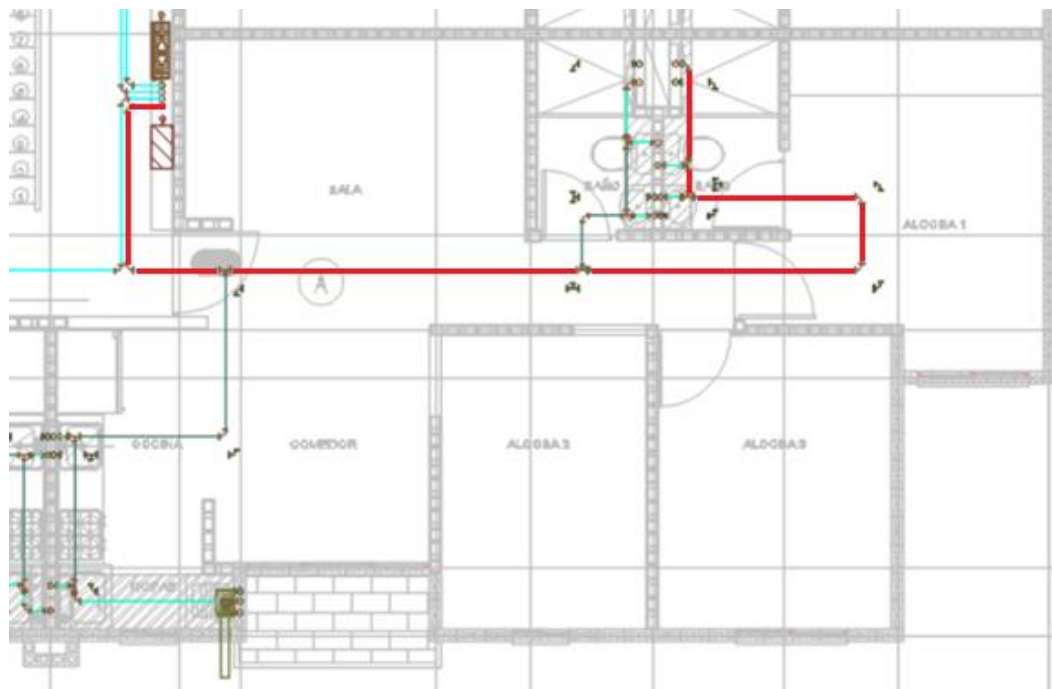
Planta arquitectónica apartamento tipo con red trazada
